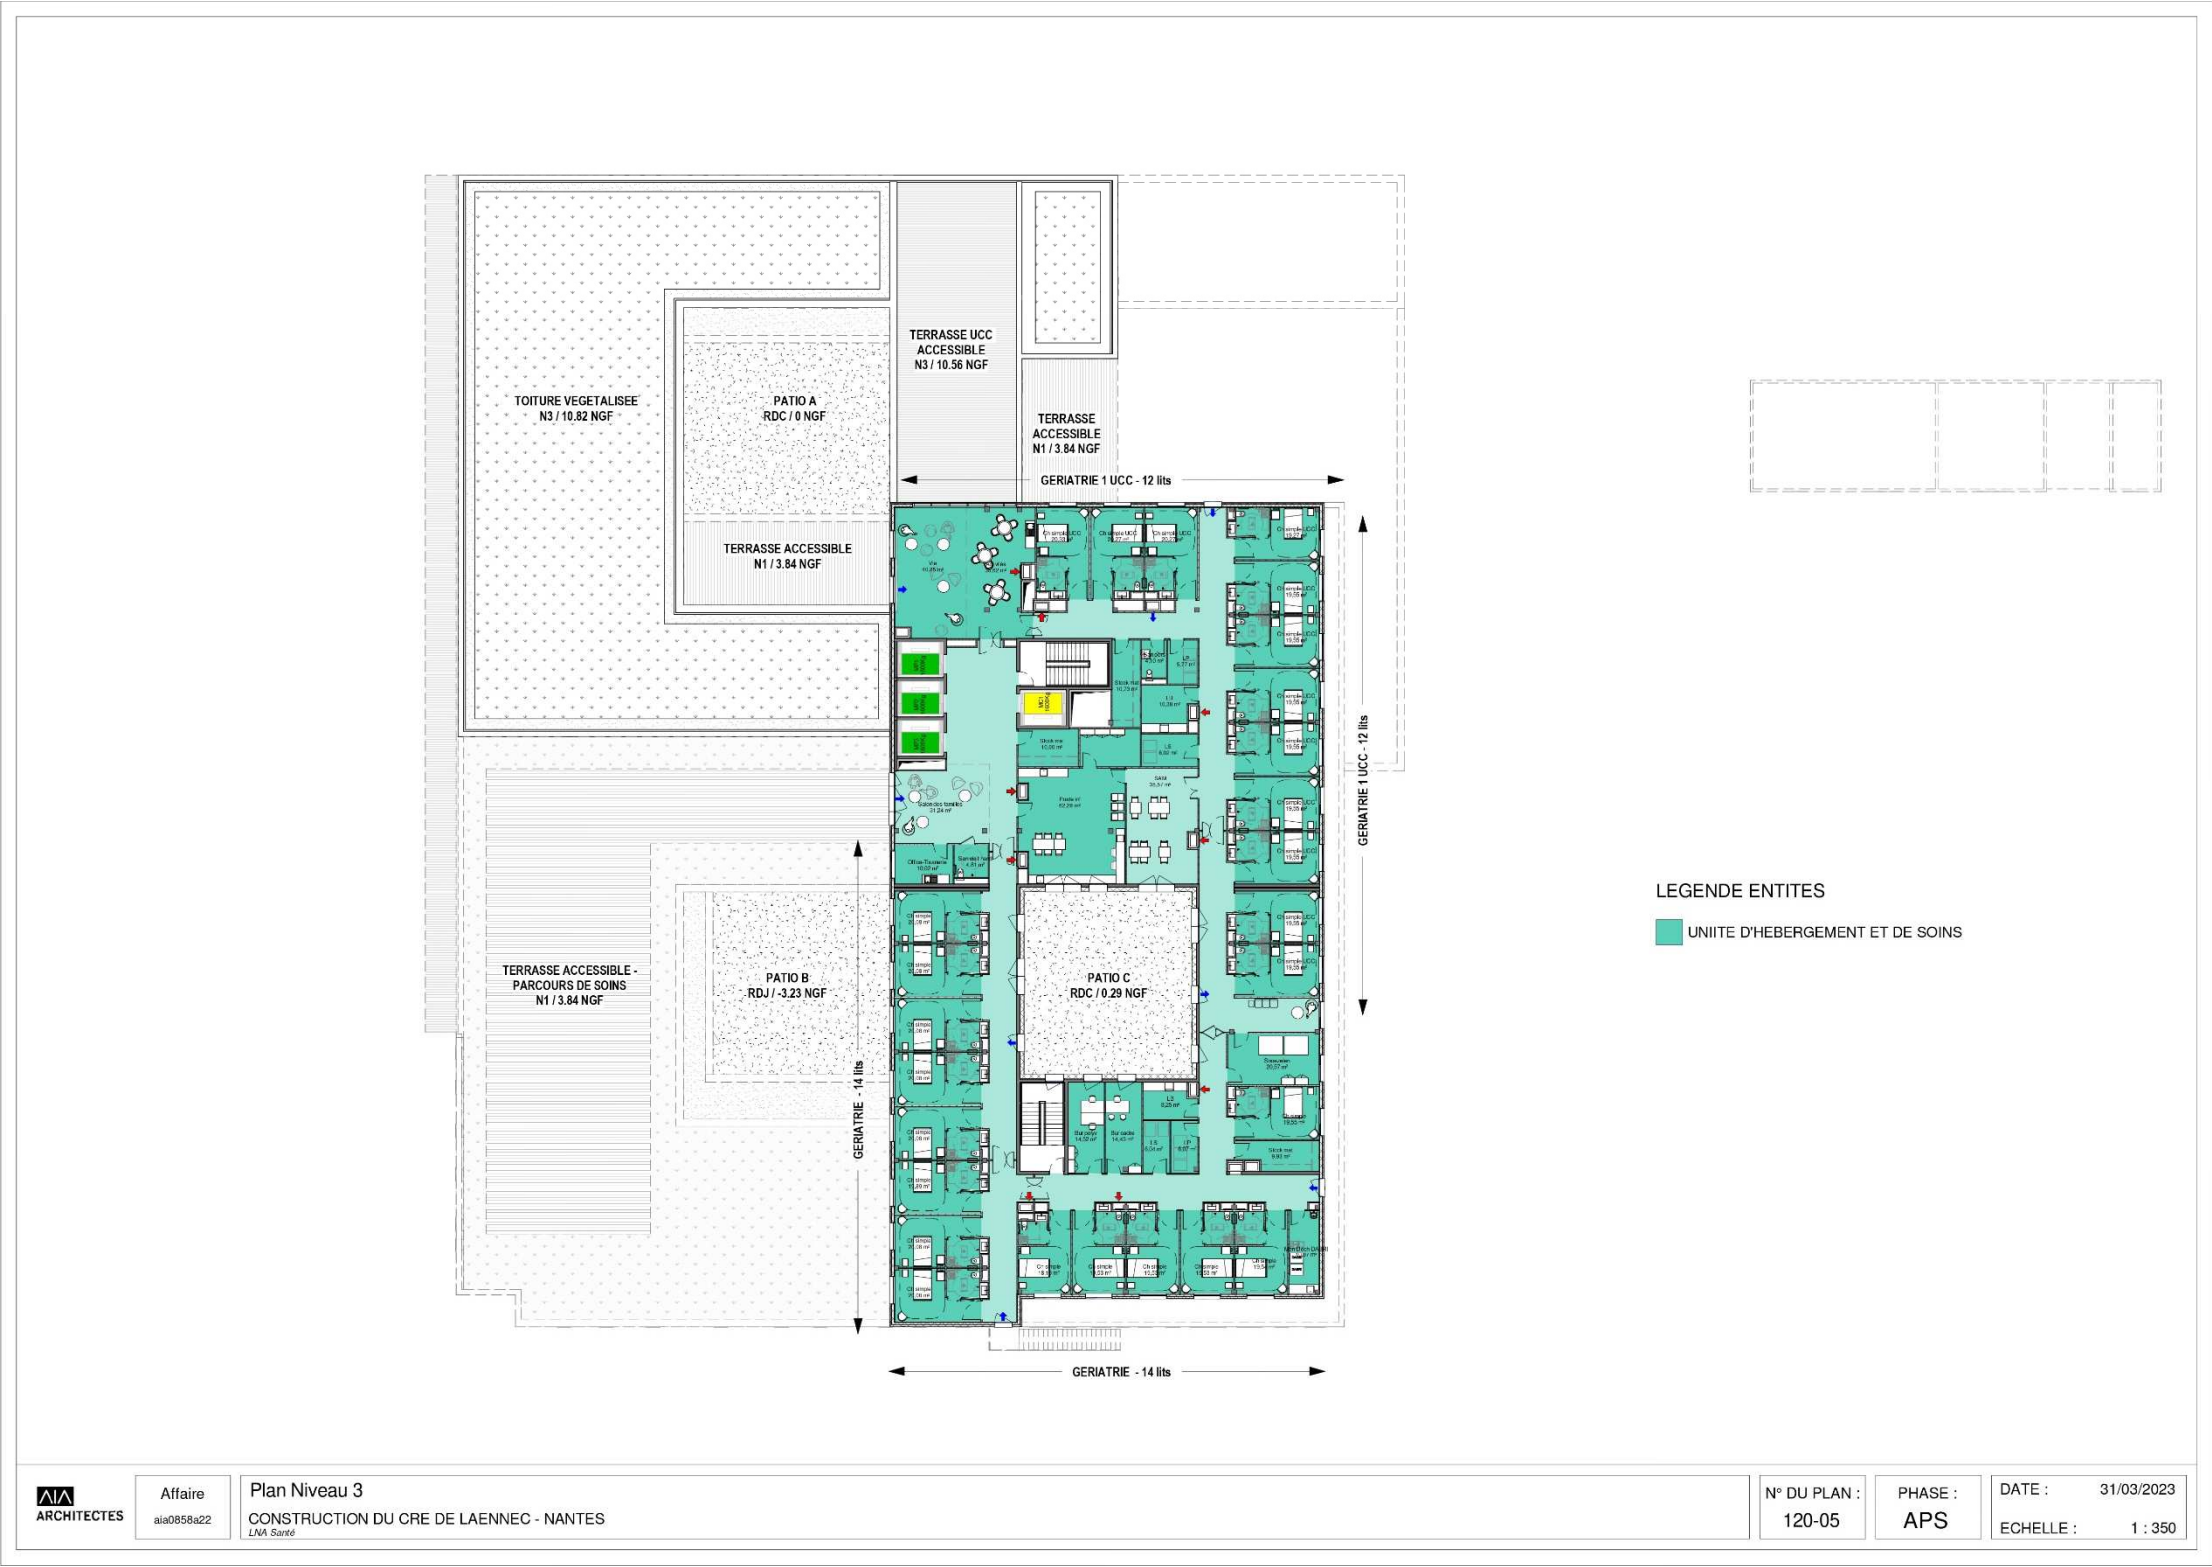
Plan de Niveau 3 (source: AIA Architectes, 31/03/2023)
